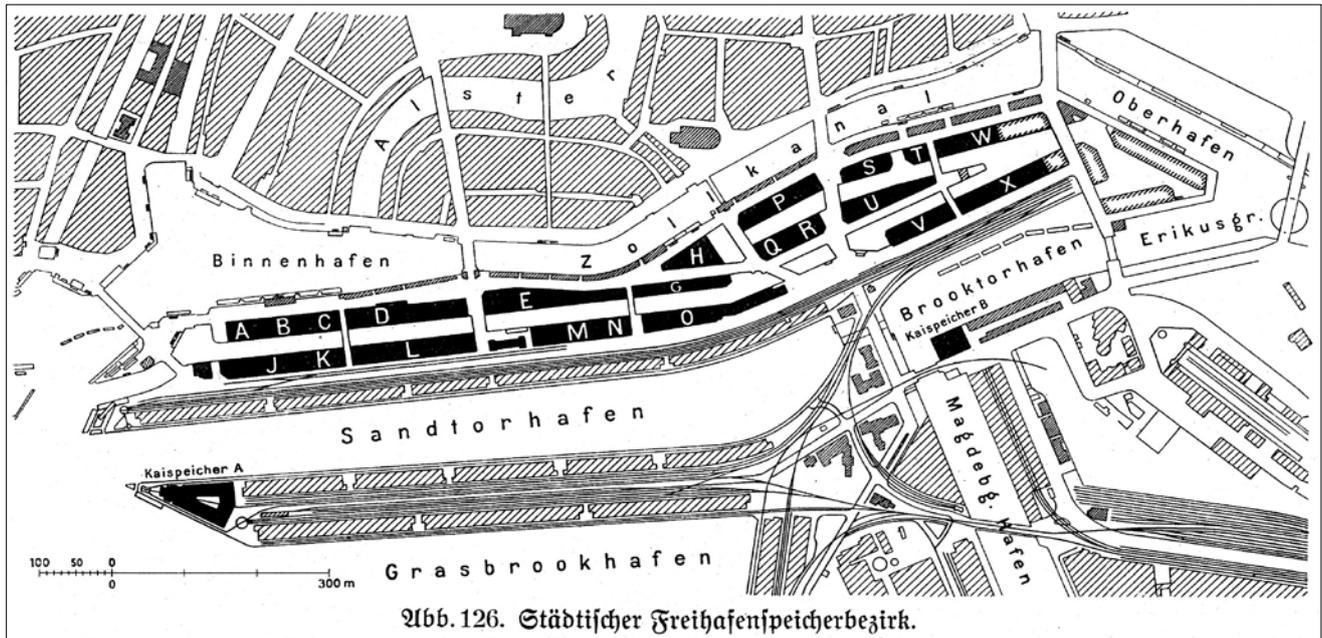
Lageplan der Speicherstadt mit den Blockbezeichnungen (1914)
